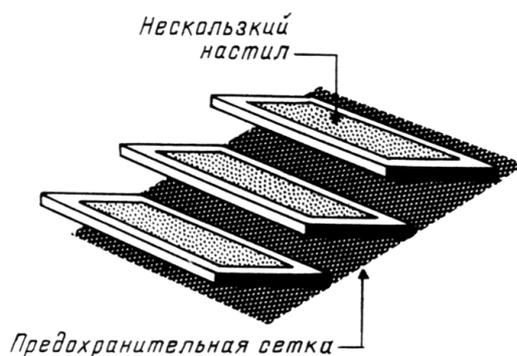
Конструкция предохранительной сетки для открытых лестниц (например на виадуки)
